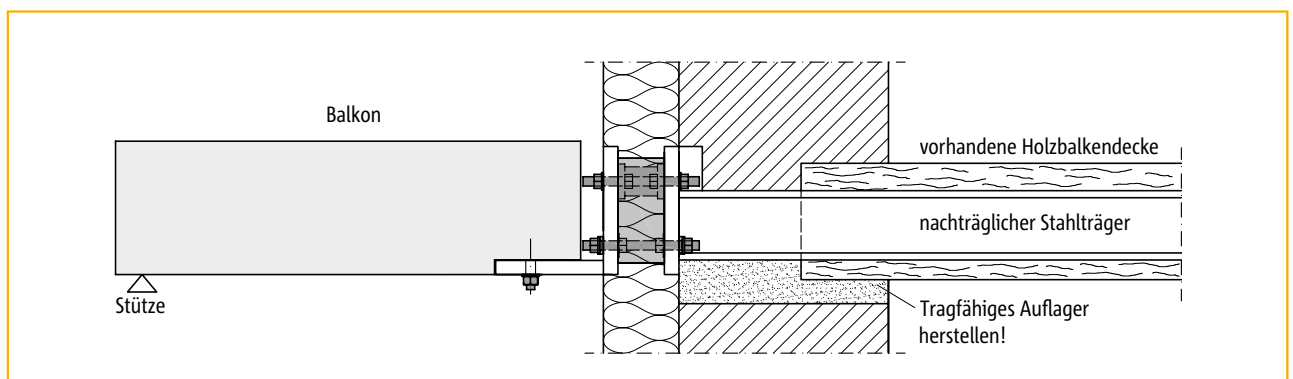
Balkon gestützt, angeschlossen mit Typ KST an Holzbalkendecke (Beton-Fertigteile)
